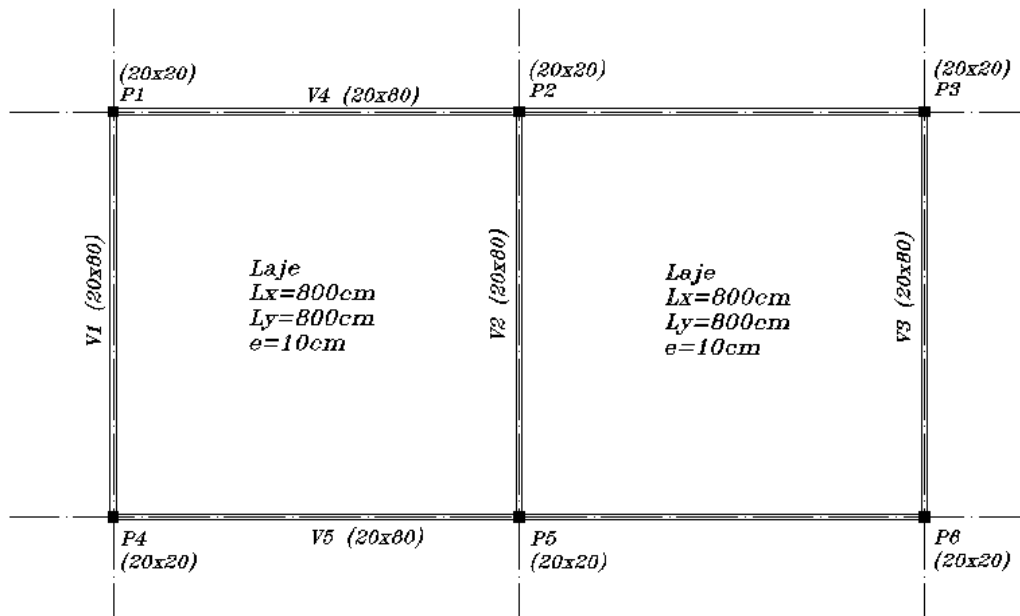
Planta de formas de um pavimento em concreto armado
